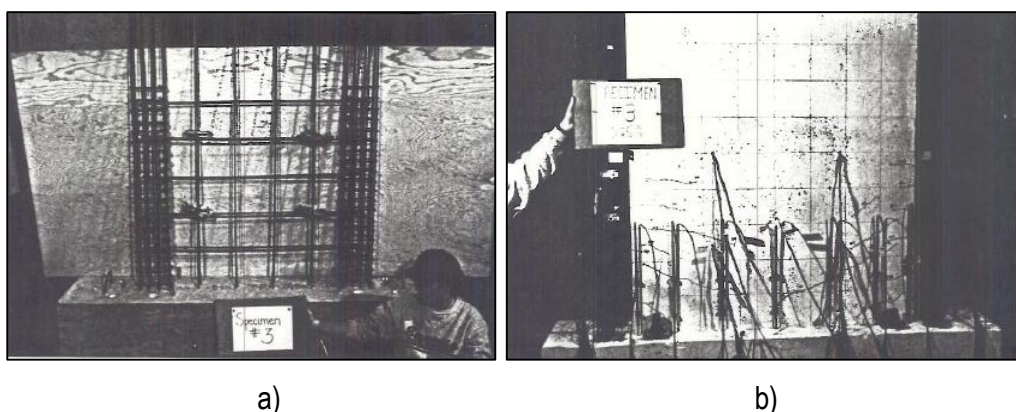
En a) exposición del acero de refuerzo en etapa constructiva y en b) configuración de instrumentos durante el ensayo cíclico, espécimen RW2 (Thomsen & Wallace, 1995).
